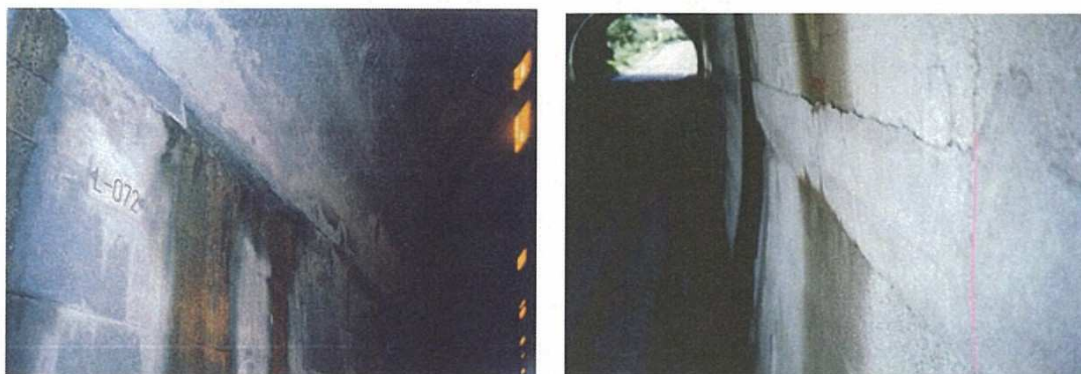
逆巻き工法の縦断方向打ち継目と化粧モルタルの施工状況
